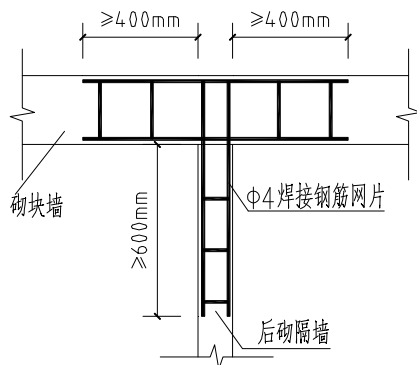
砌块墙与后砌隔墙交接处钢筋网片
